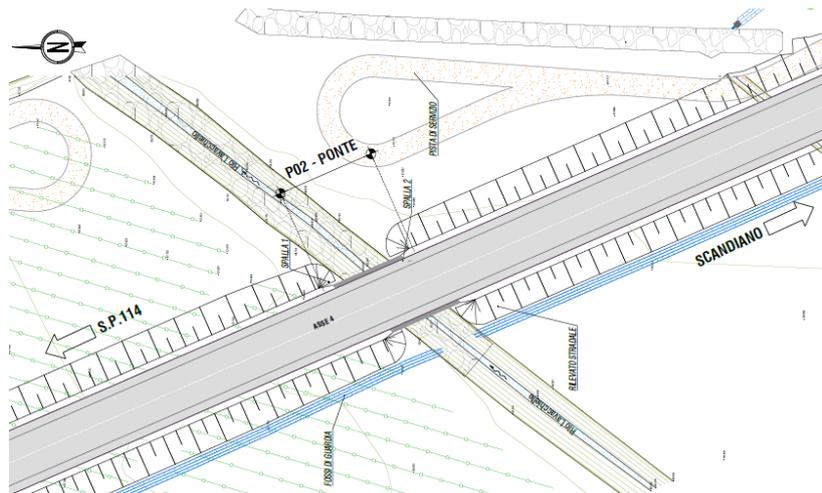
Stralcio planimetrico del ponte P02 su Rio Lavacchiello.
